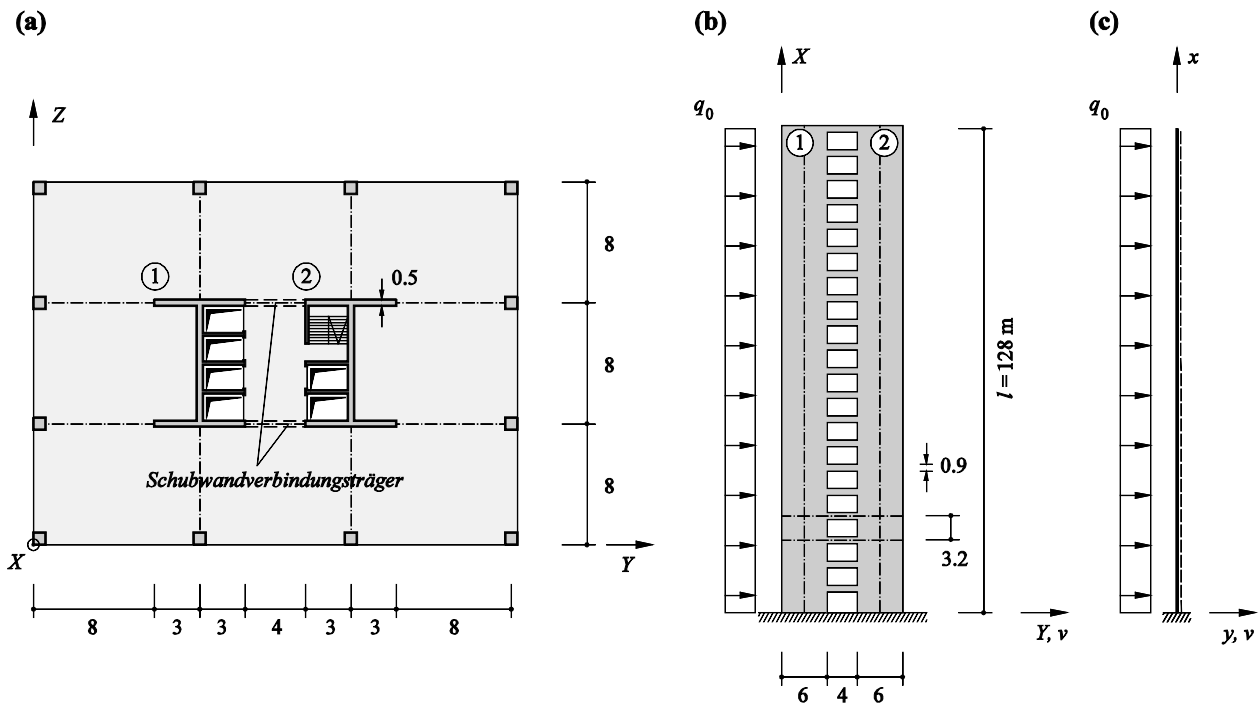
(a) Regelgrundriss (Abmessungen in m); (b) Aufriss und Belastung (Abmessungen in m) und (c) Idealisiertes System.
